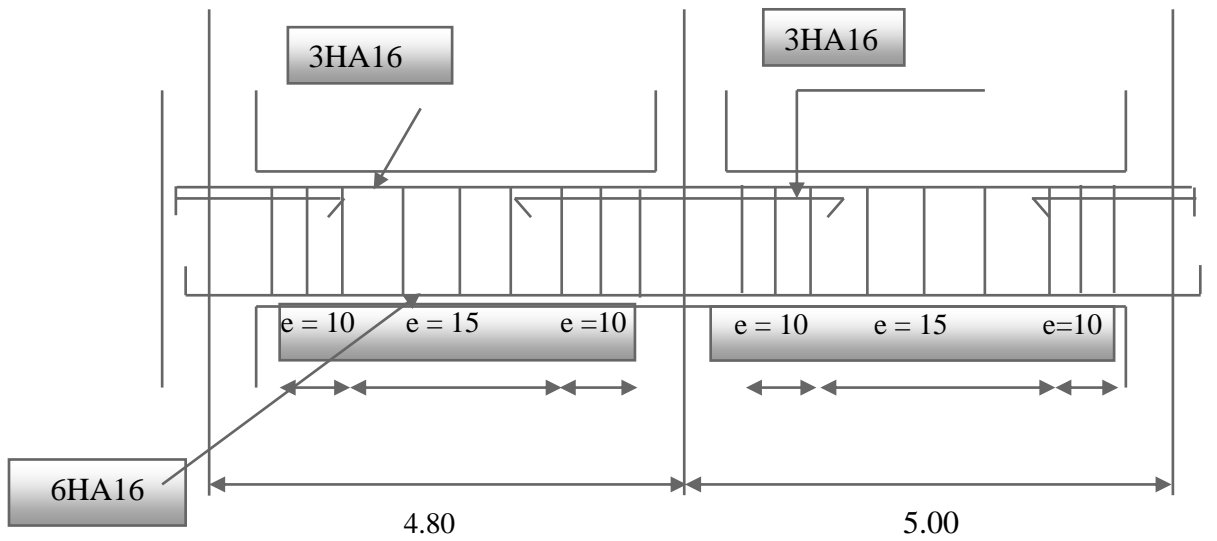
Disposition constructive des armateurs dans les poutres.
